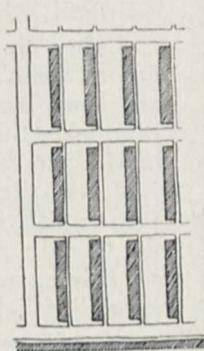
Moderner Zeilenbau. Alle Wohnungen haben günstigste Lage, alle Wohn- und Schlafzimmer Sonne
